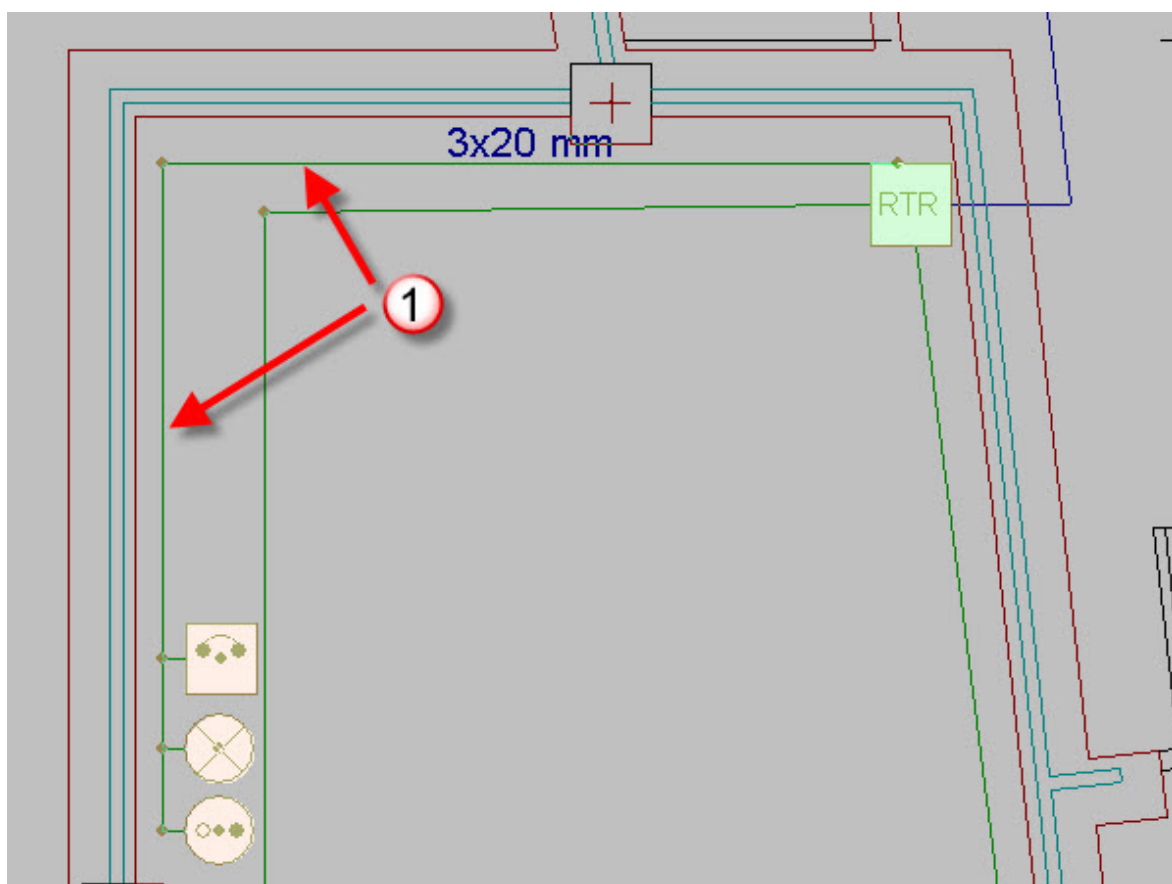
DETALLE Instalación ICT planta semisótano (dimensionada)
